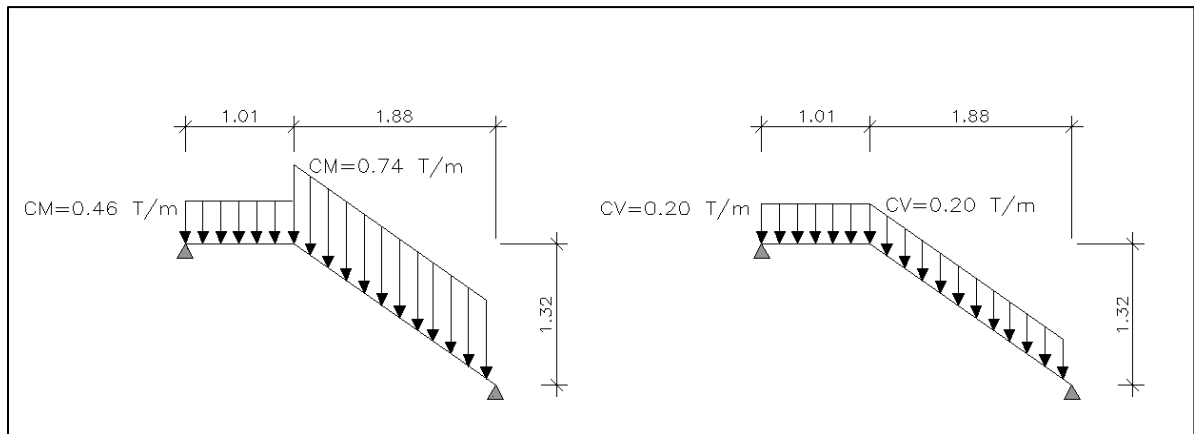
Metrado de cargas del primer tramo típico.
